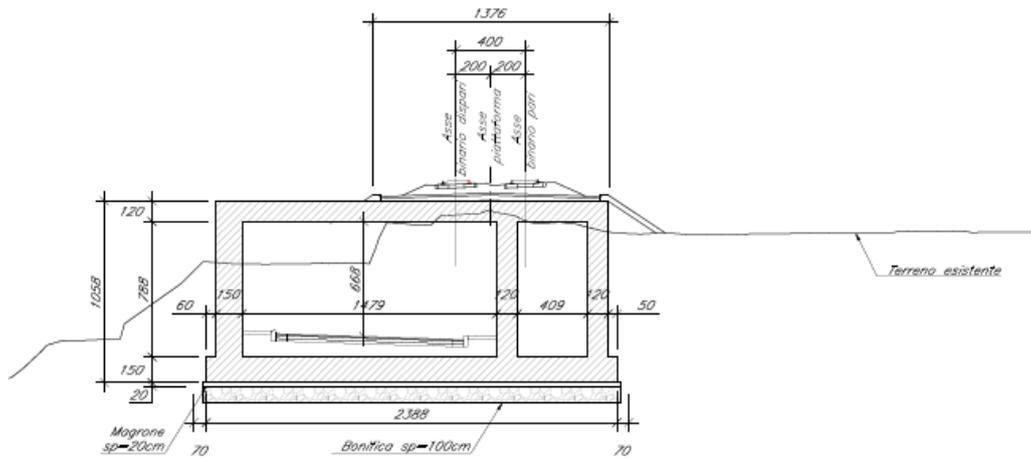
SL25 – Sezione trasversale in asse ferrovia
